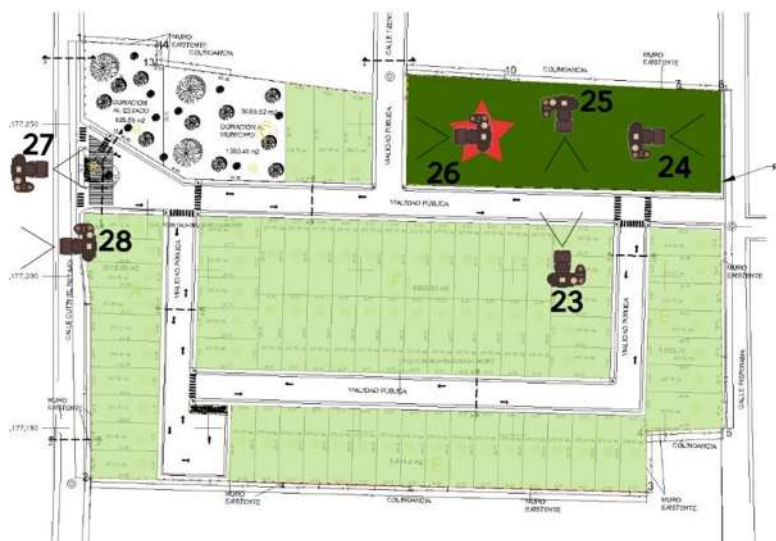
Paisaje urbano del predio y de la zona inmediata referenciando las fotos de las vistas del capítulo 3.4.4. Ireri Loza
